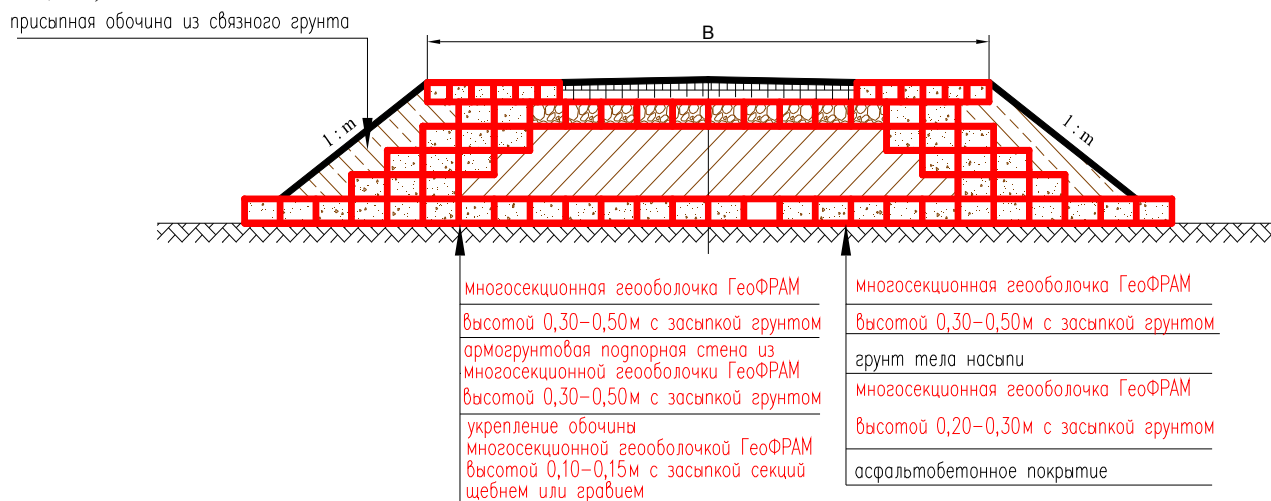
Земляное полотно с устройством армогрунтовых стен
